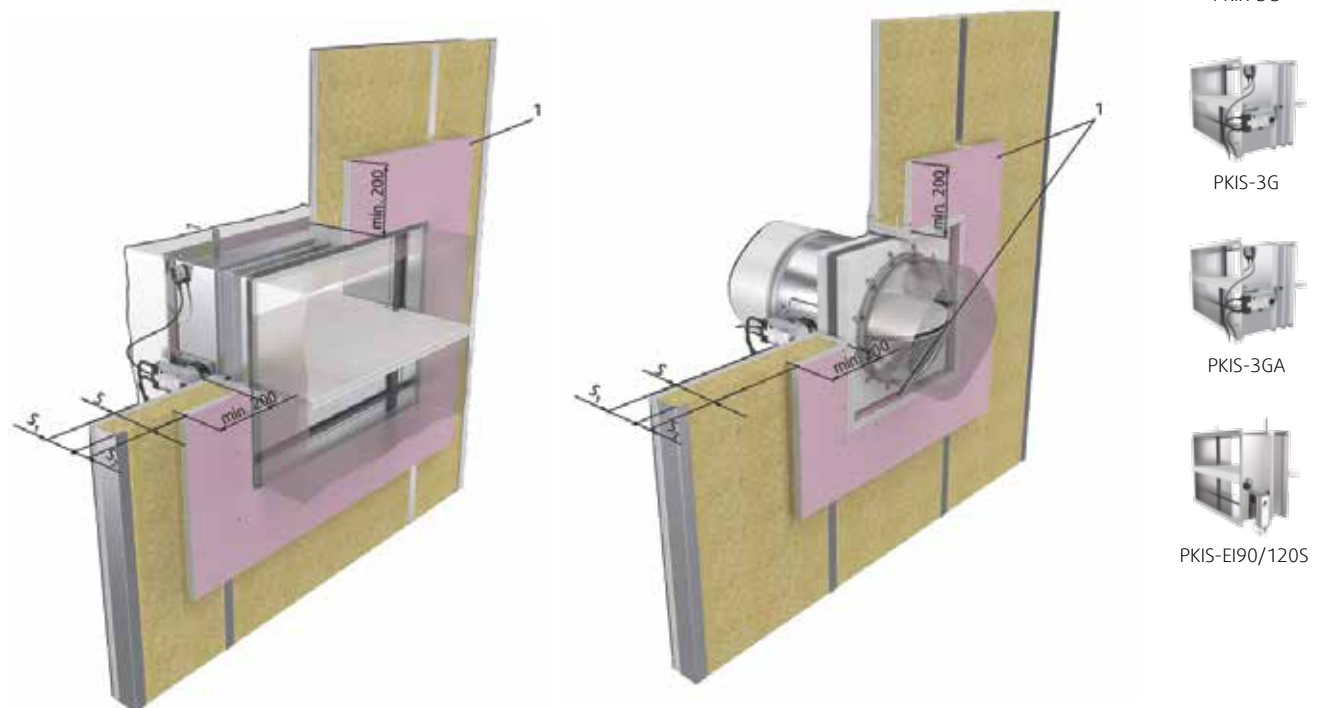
Instalace mimo/na požárně dělicí konstrukci
